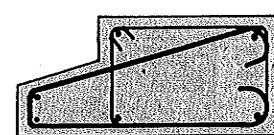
Rives d'un palier en B.A. avec becquet et poutre incorporée destinés à supporter une volée d'escalier.
